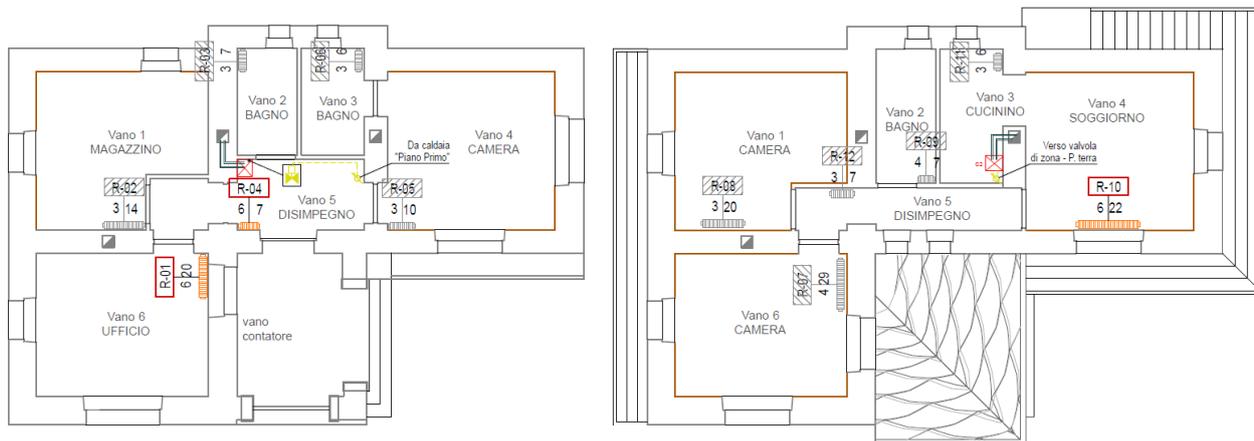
Planimetria post operam: radiatori di progetto – Piano terra e piano primo
